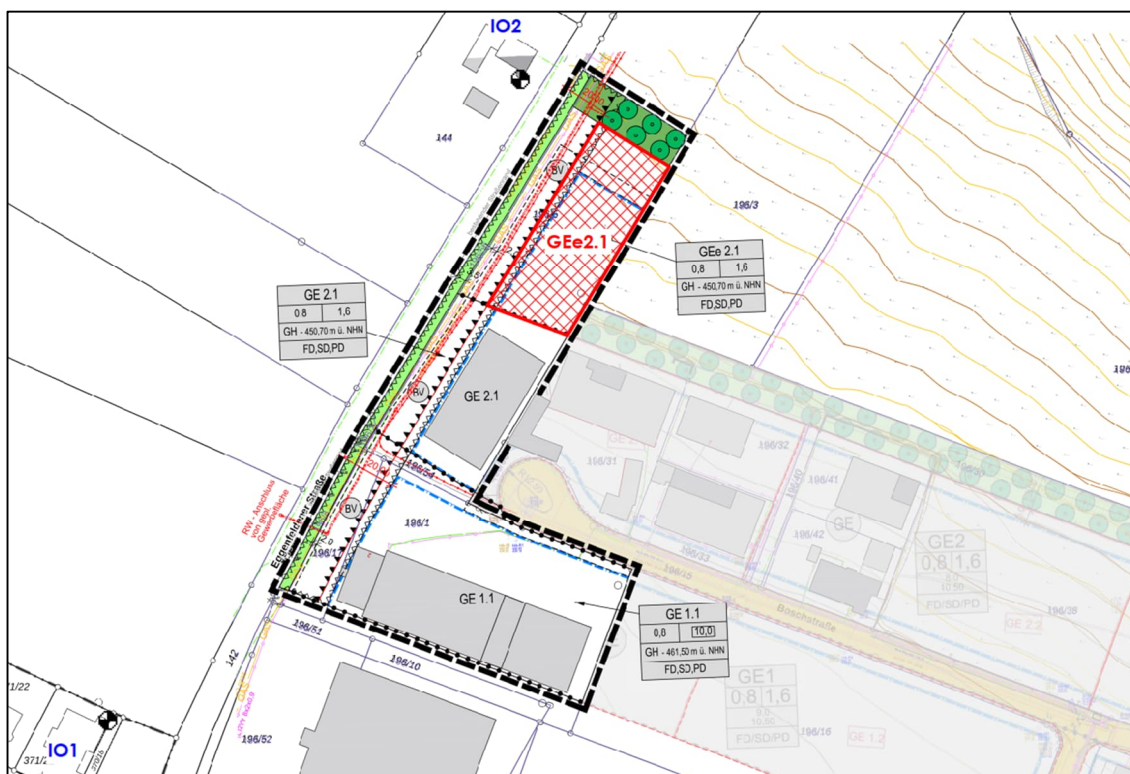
Lageplan /7/ mit Darstellung der Emissionsbezugsfläche
